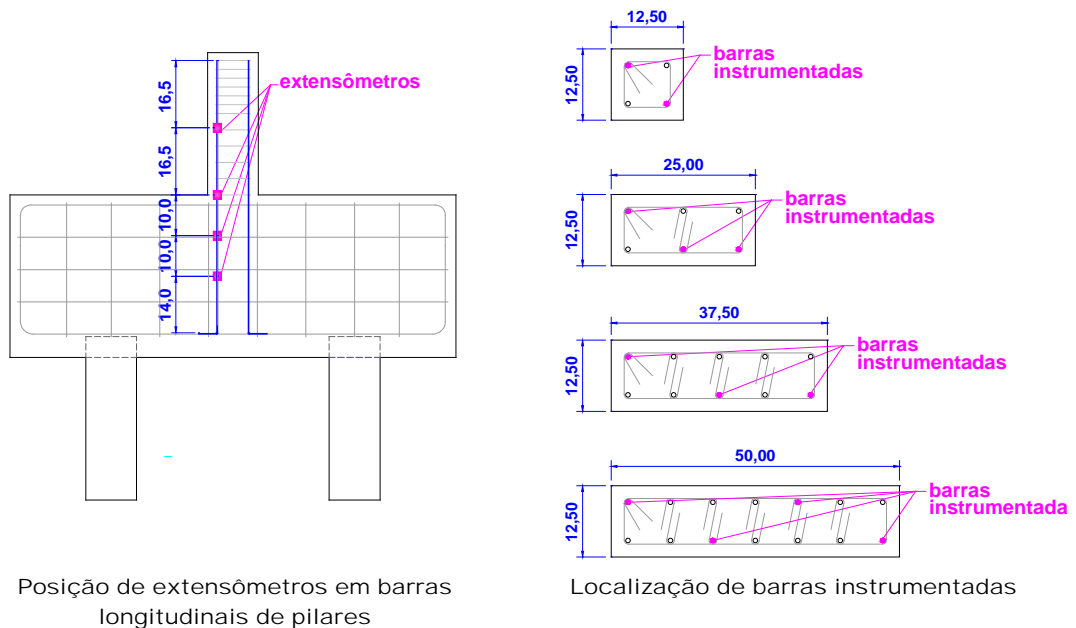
Posições dos extensômetros elétricos nas barras de armadura dos pilares
